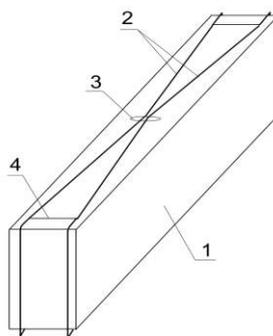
Обойма из стальной проволоки (арматуры) при натяжении на продольной грани балки; 1 – каменная балка; 2 – обойма; 3 – стяжное устройство; 4 – распорка
